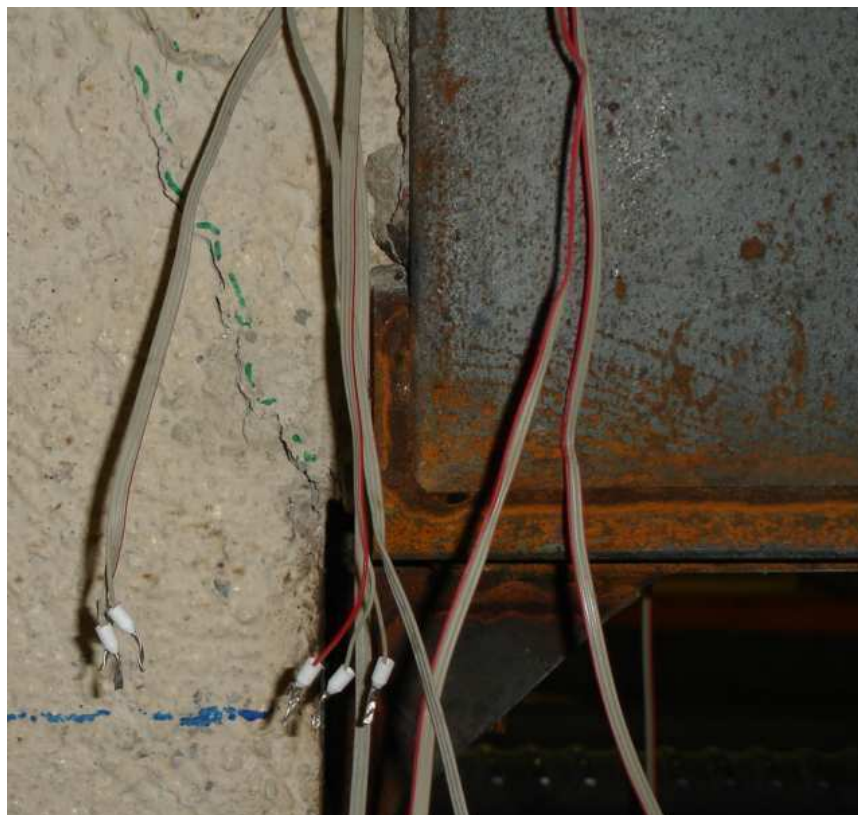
Fisuración de tracción aparecida en el entronque del soporte con el nudo, en las probetas B-L2
